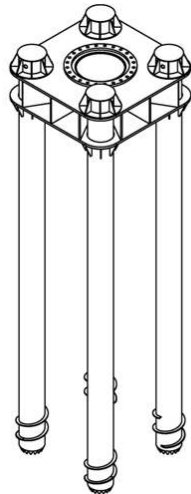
Фундамент из винтовых свай с металлическим ростверком.
